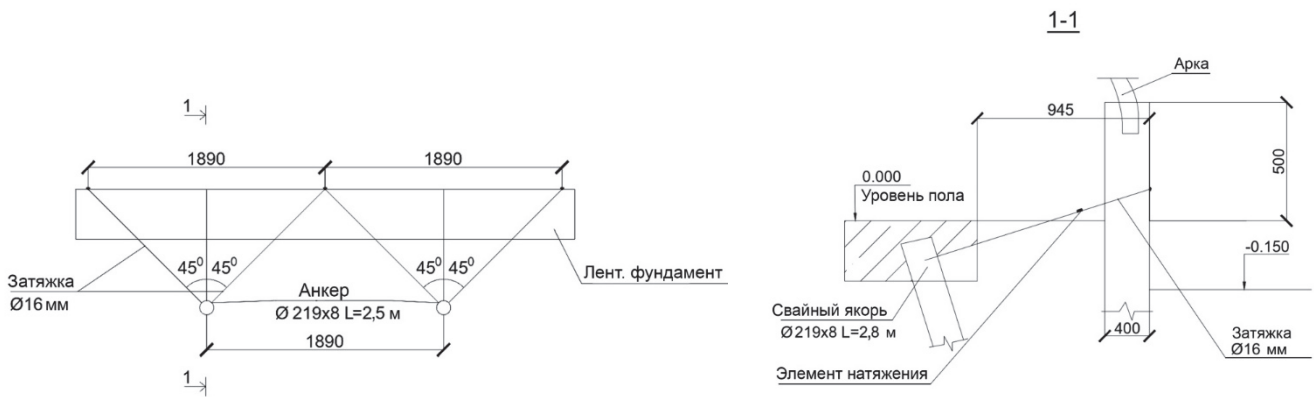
Вариант 1. Установка затяжек в ленточном фундаменте арочного здания со свайными стальными анкерами
